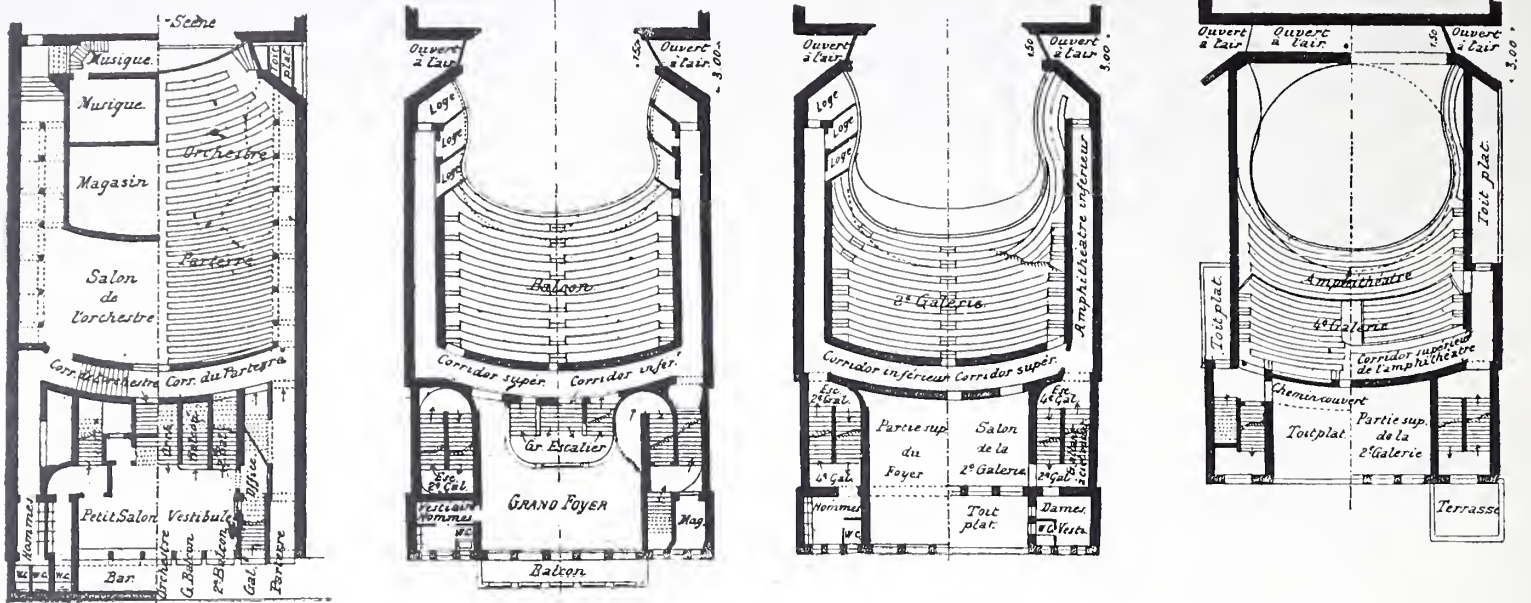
Plans du théâtre de sûreté. Type de M. M. Roë.
